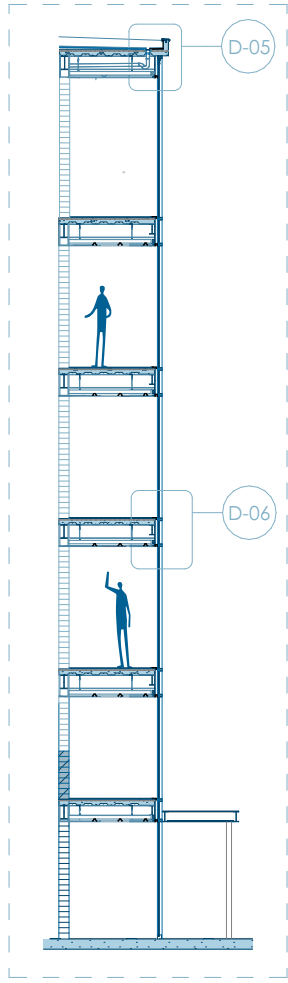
Sección constructiva C. Nota. Elaboración propia.
